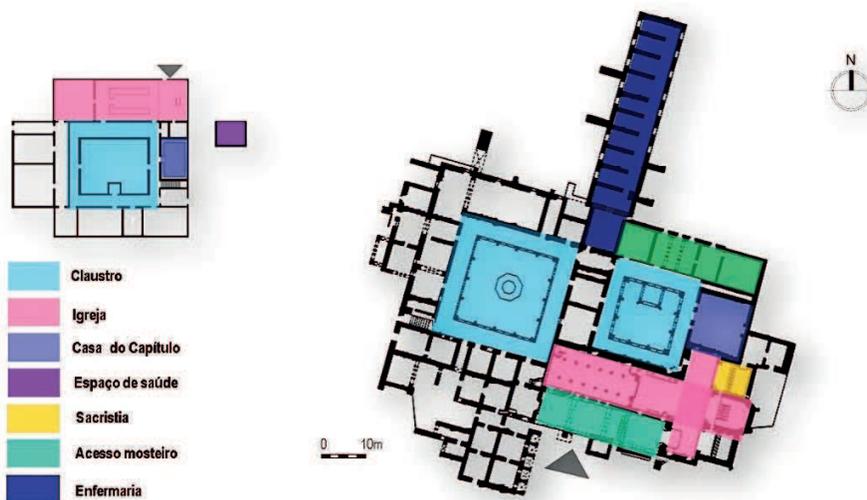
Planta do piso térreo do mosteiro. Fonte: planta desenhada por M. C. Tereno com base em Ana Tavares Martins.
